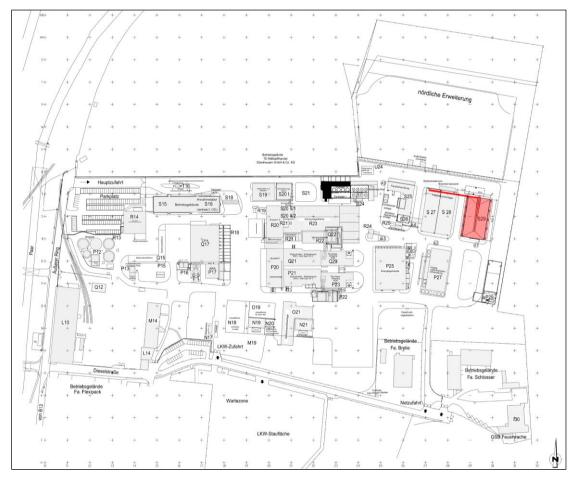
Lageplan der geplanten Stückgutabstellfläche S29 (Quelle: IA-Tech GmbH)
